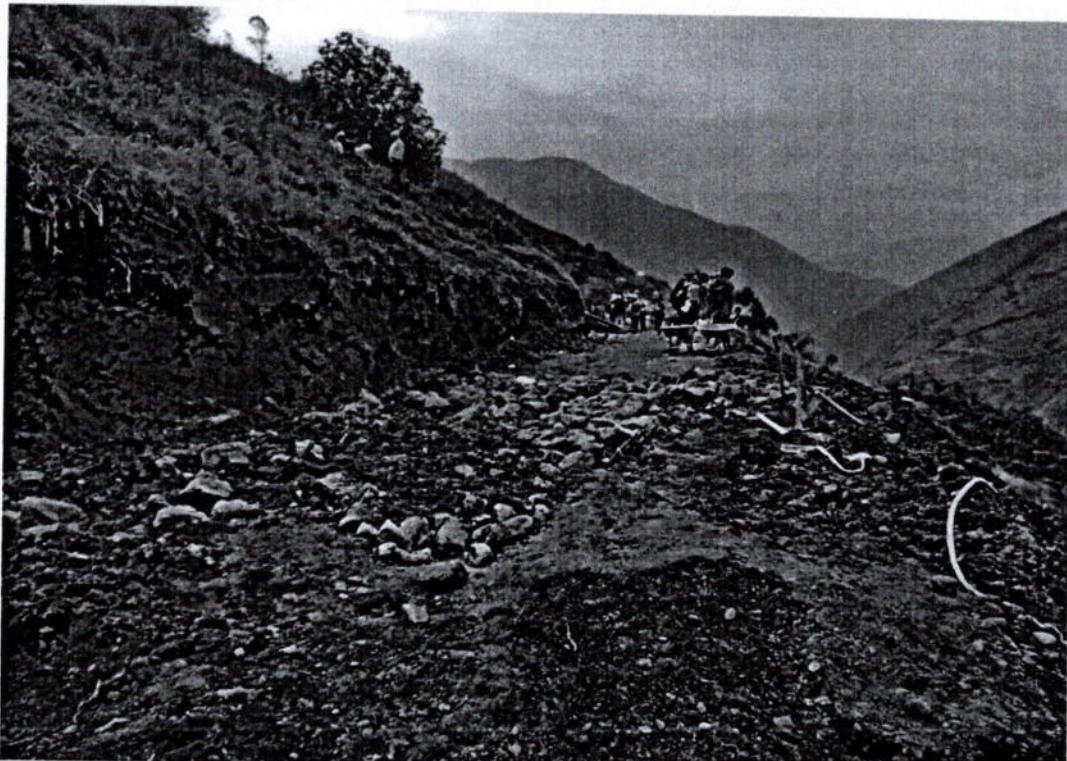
vista de algunas piedras pertenecientes a muros de contención de las andenerías, las cuales se encuentran tendidos sobre la trocha carrozable (inspección 09/10/2024).
